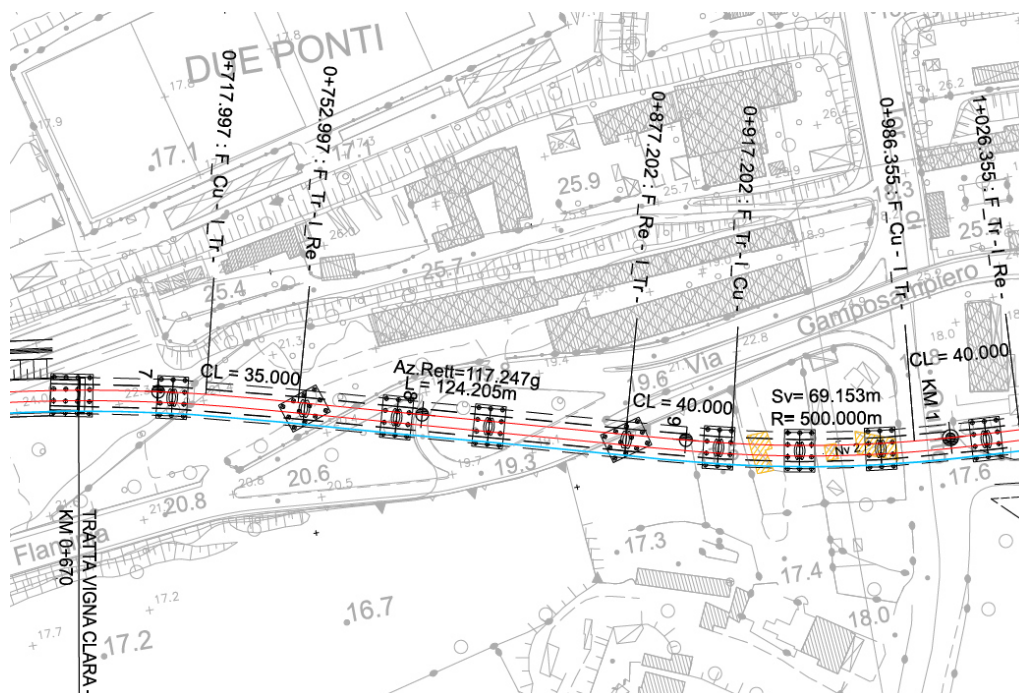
Stralcio planimetrico: intersezione con via Flaminia Vecchia
